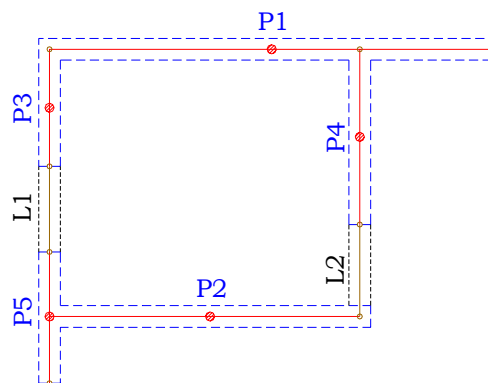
Planta baixa da modelagem tridimensional dos painéis de contraventamento com elementos barra
